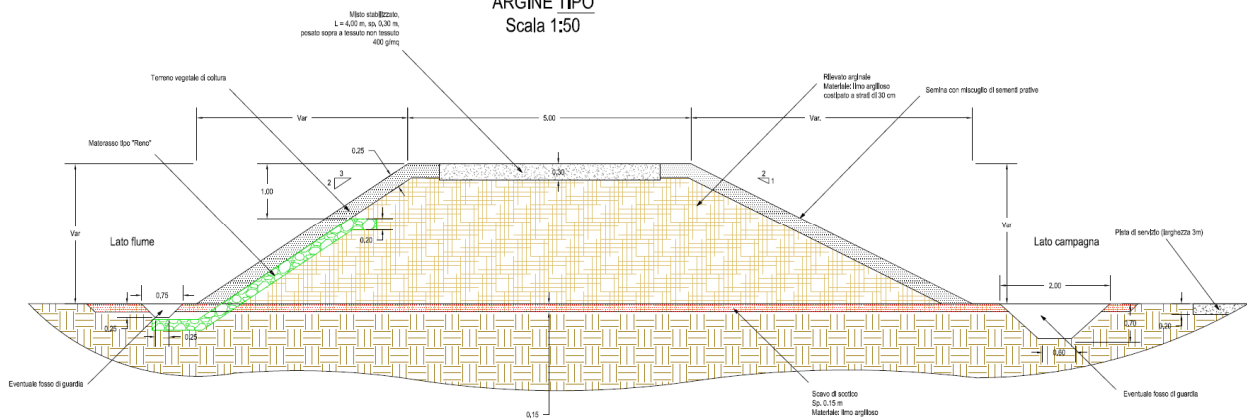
planimetria e sezione tipo argine destro a monte del ponte
